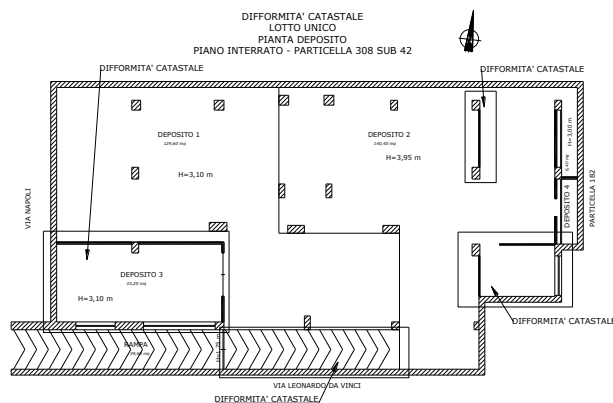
planimetria delle difformità catastali del deposito al piano interrato
